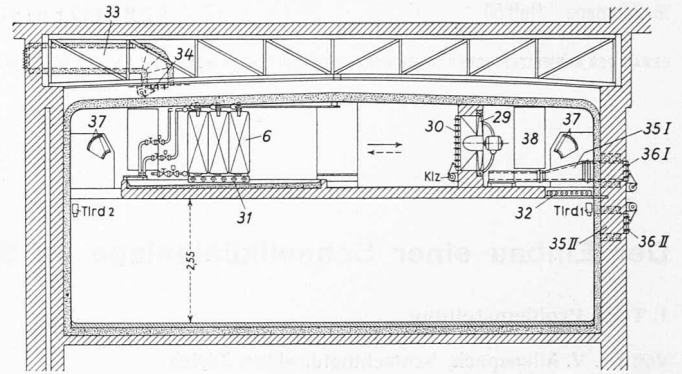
Längsschnitt durch einen Schnellkühlraum mit zugehörigem Luftkühlerraum, Legende der Ziffern siehe Bild 11, Seite 813
